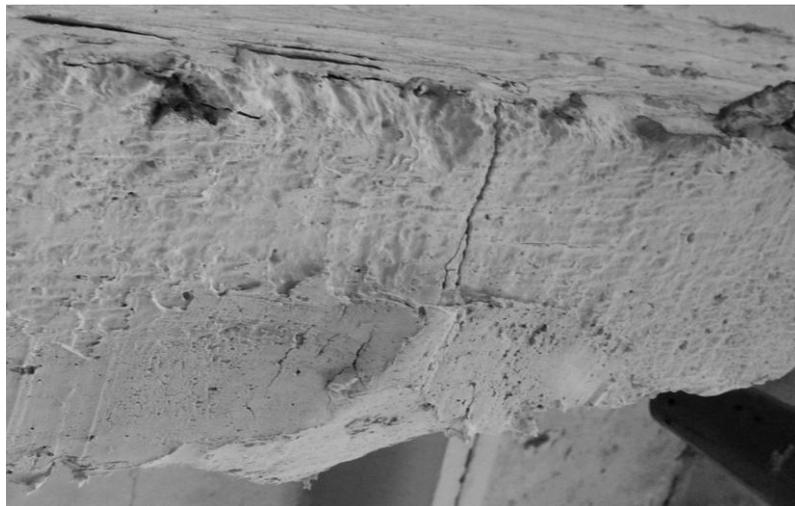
Трещина по нижнему поясу балки покрытия по оси «9» пролета «А-Б» шириной раскрытия 0,5 мм. На трещине установлен «маяк» из алебастрового раствора 12.03.2014 г.
